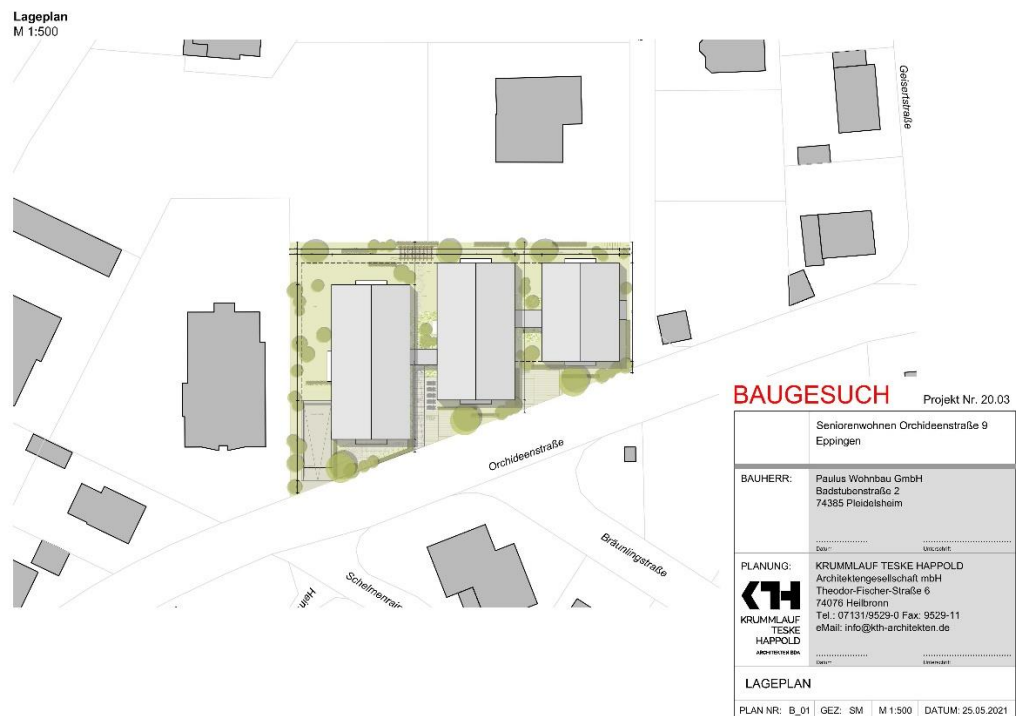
Lageplan zum Baugesuch, Stand 25.05.2021, Paulus Wohnbau GmbH / Krummlauf Teske Happold Architekten, Heilbronn.
